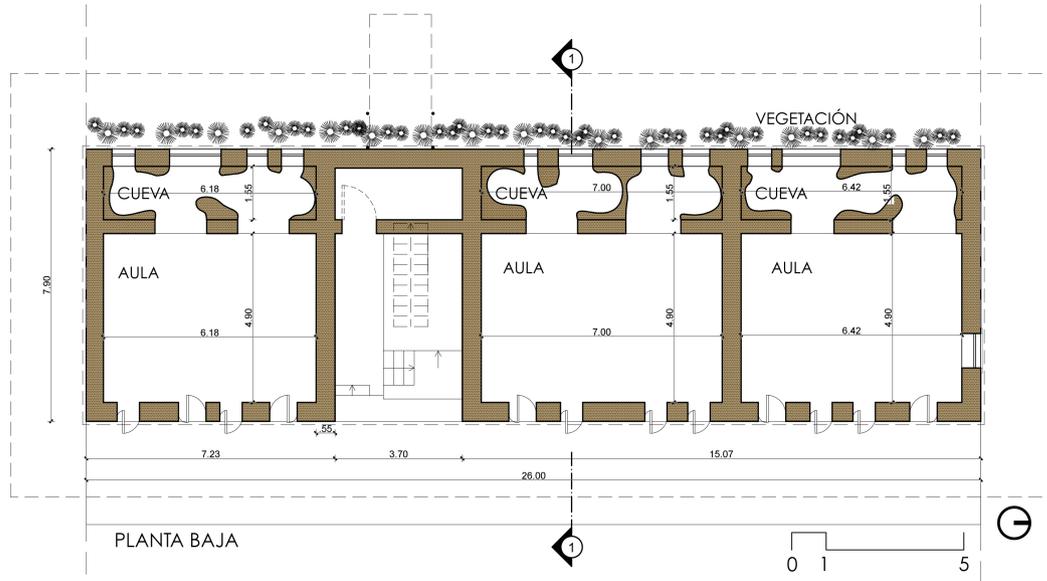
Planta Baja. (Fuente: Elaboración Propia tomado del portal de Anna Heringer y redibujado.)
